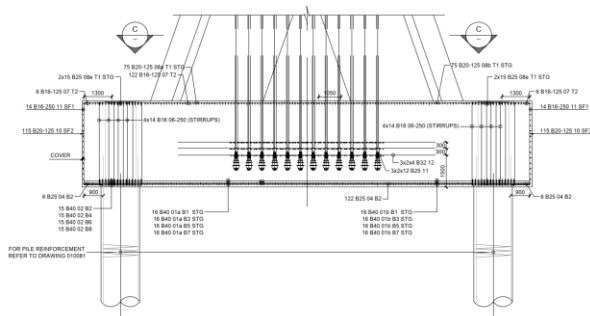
Sección por el encepado de retenida intermedia (CSB02/CSB05).
